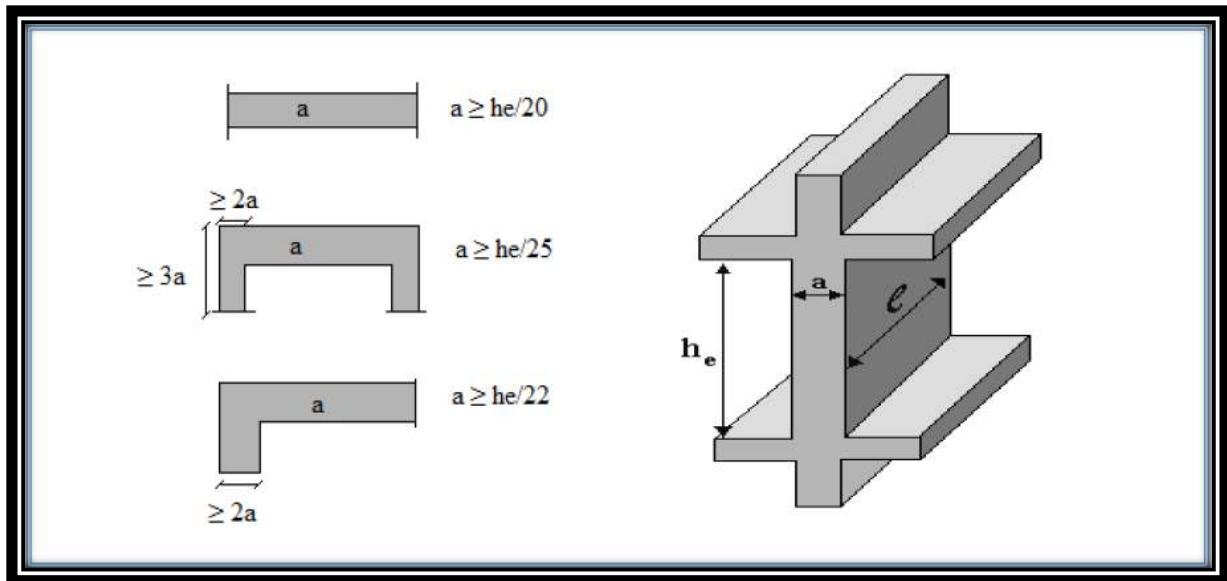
Coupe de voile en plan (gauche) Voile en 3D (droite).
